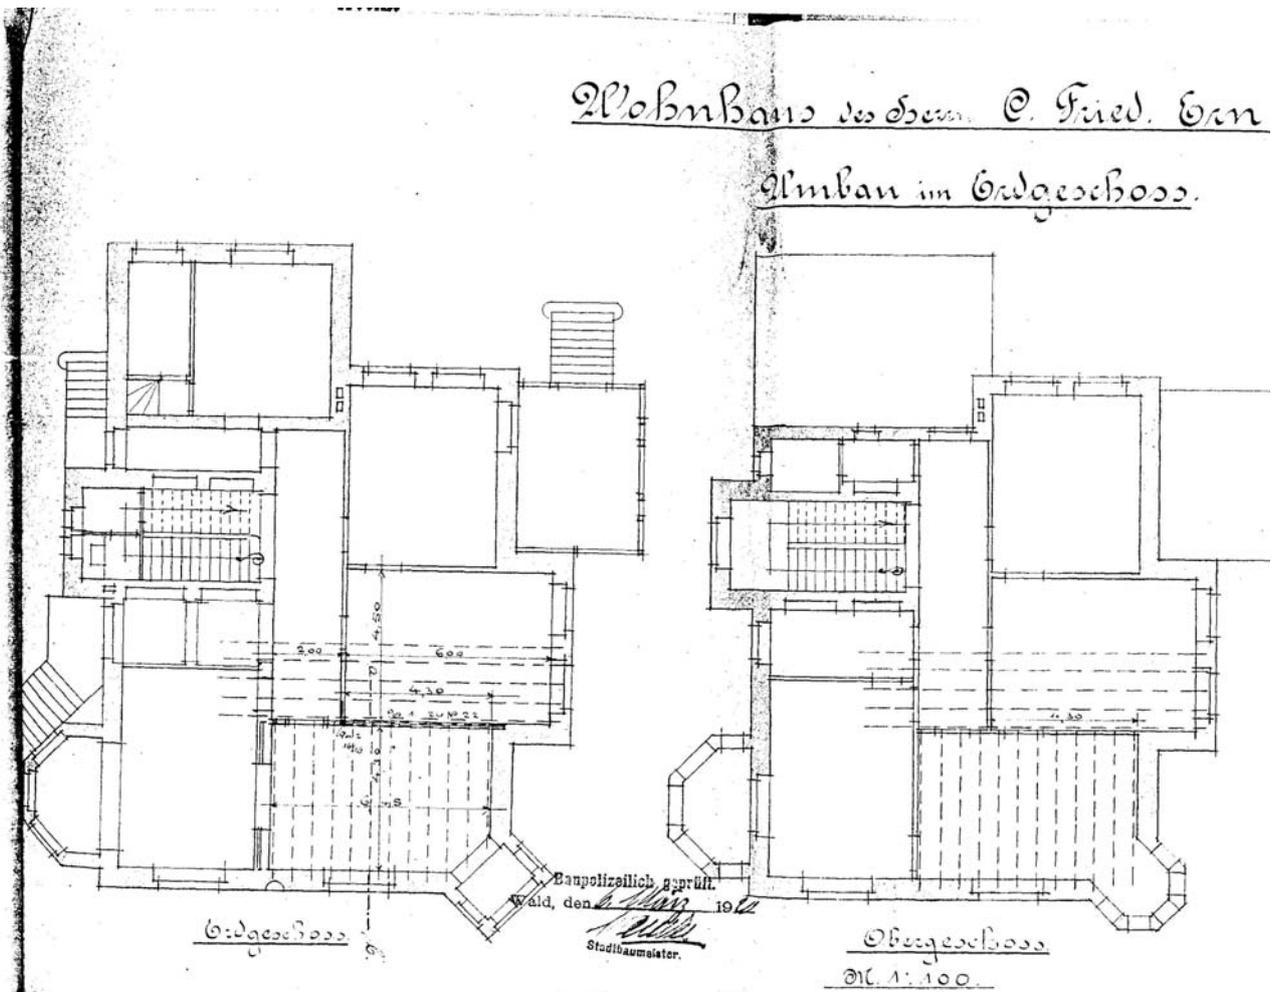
Grundrisszeichnung mit Umbau von H. Plange, Erdgeschoss (links) und Obergeschoss (rechts), 1920
